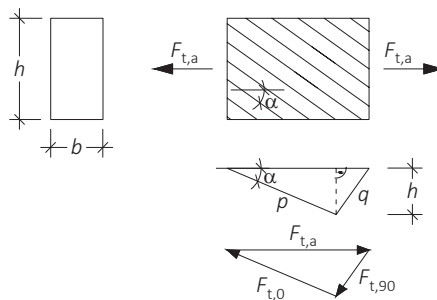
Stück Holz mit Zugbeanspruchung unter Winkel α zur Faserrichtung.
